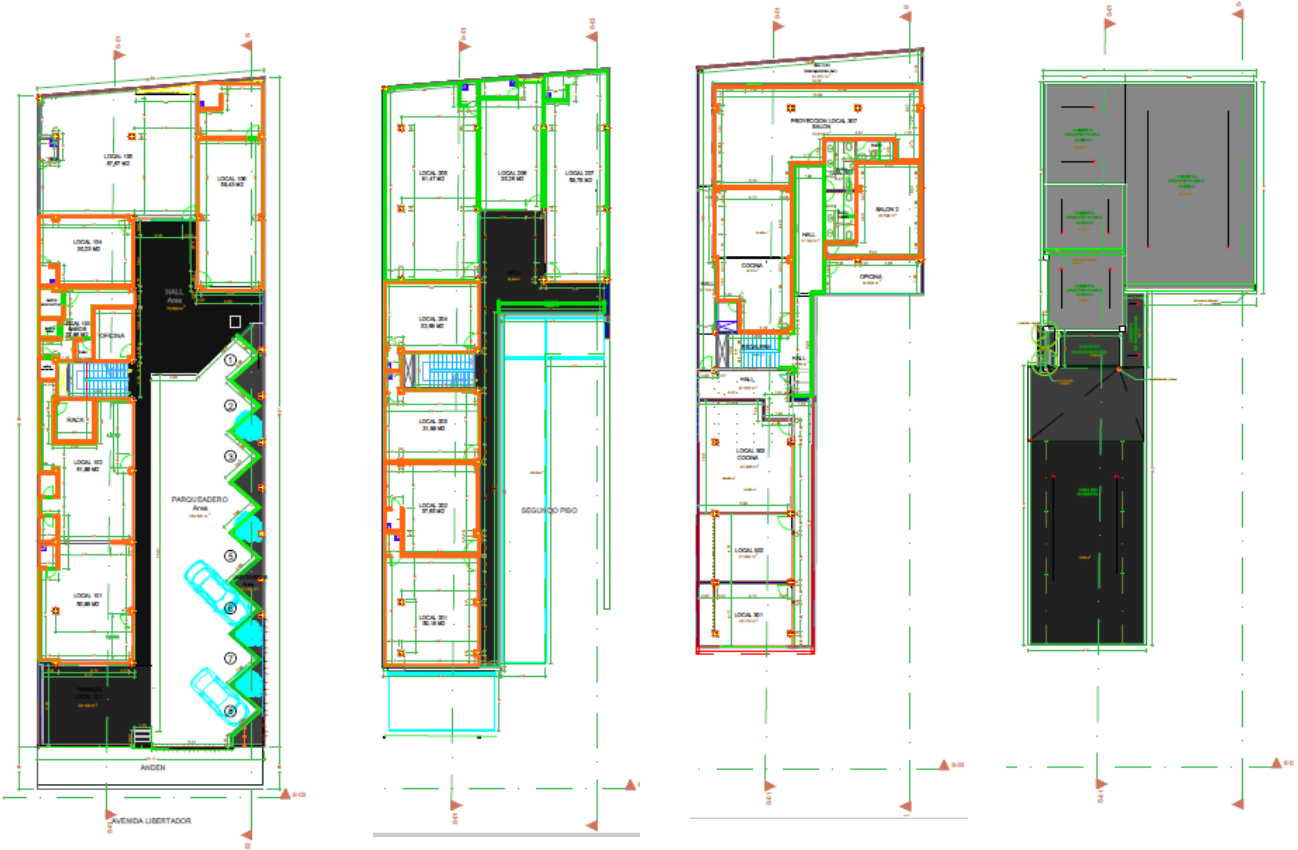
Planta 1, 2, 3 y Cubierta. Edificio Plaza Libertador Artes y Oficios. CAJAMAG.
